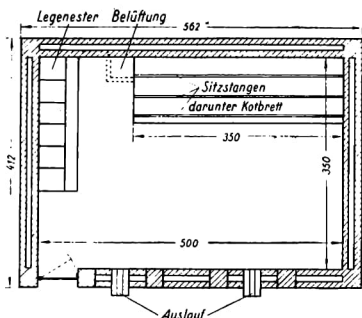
Grundriß eines Stalles für Auslaufhaltung
